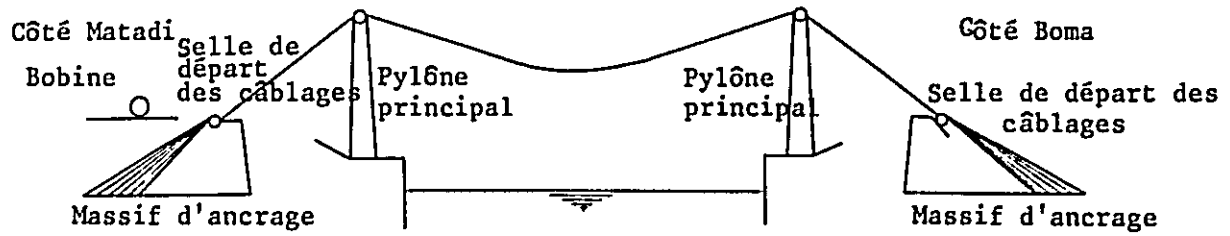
TOUR PRINCIPALE DE PONT (MATADI COTÉ) PLAN DE L'INSTALLATION
